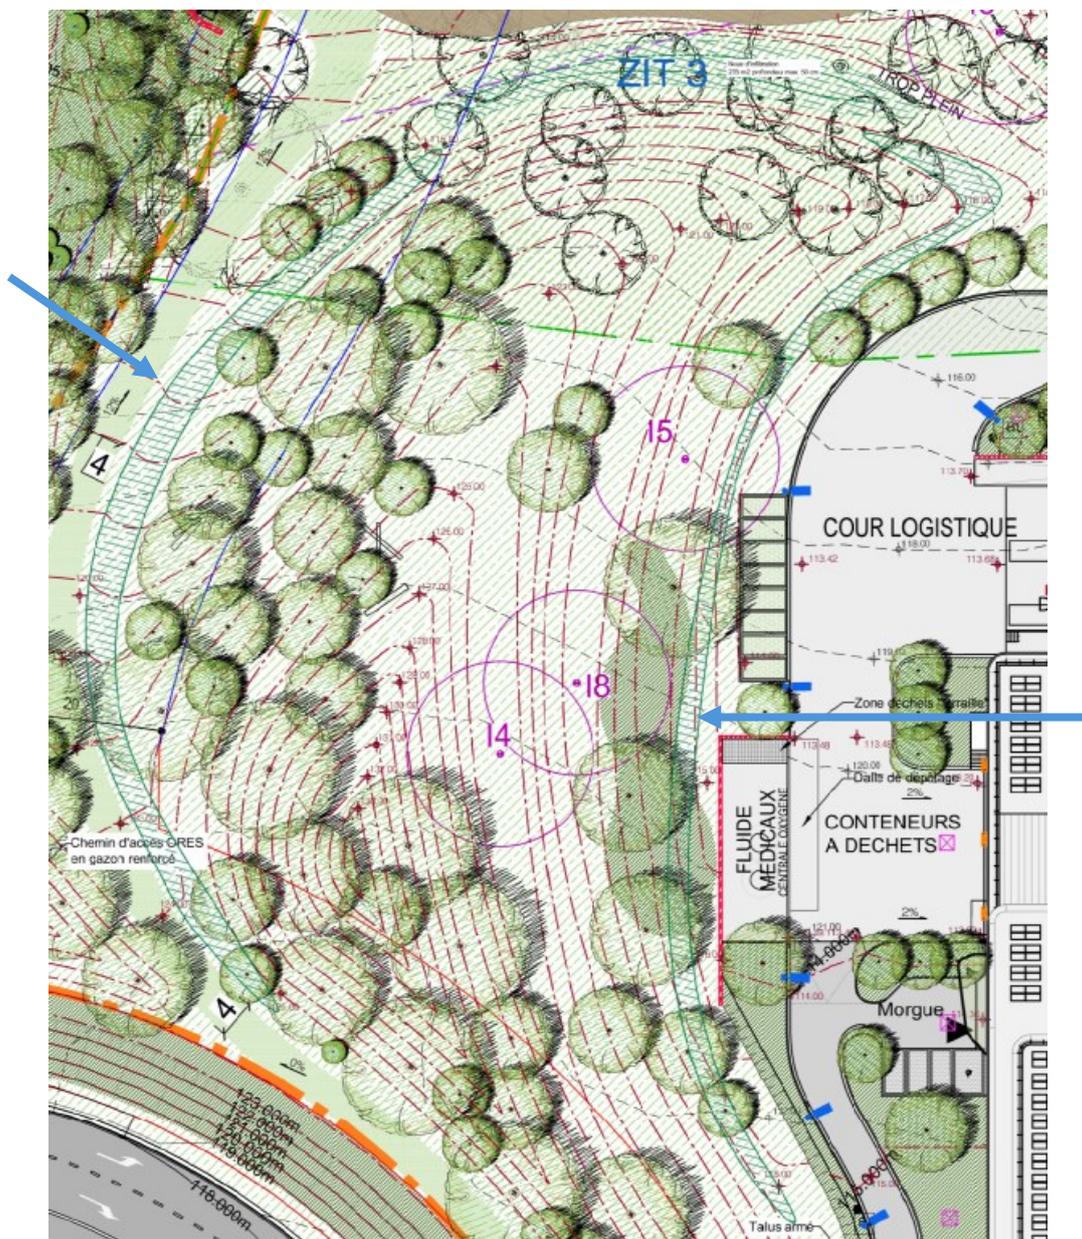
Noues de collecte et transfert des eaux de ruissellement sur le merlon : vue en plan
